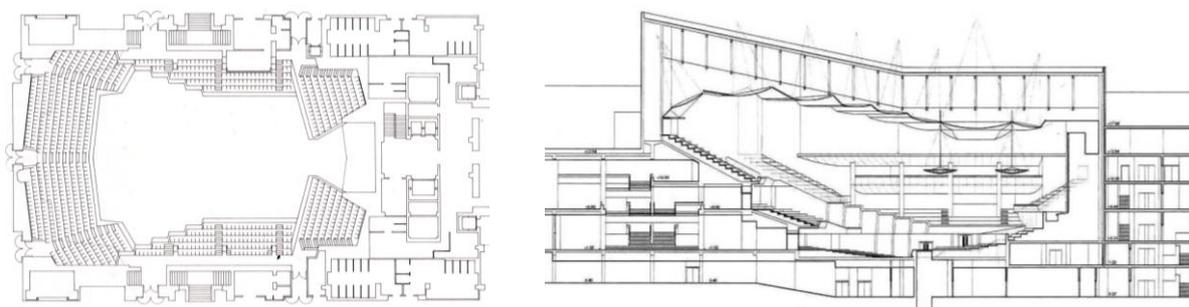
Auditorio Nacional: planta (cota 6,46) y sección longitudinal
